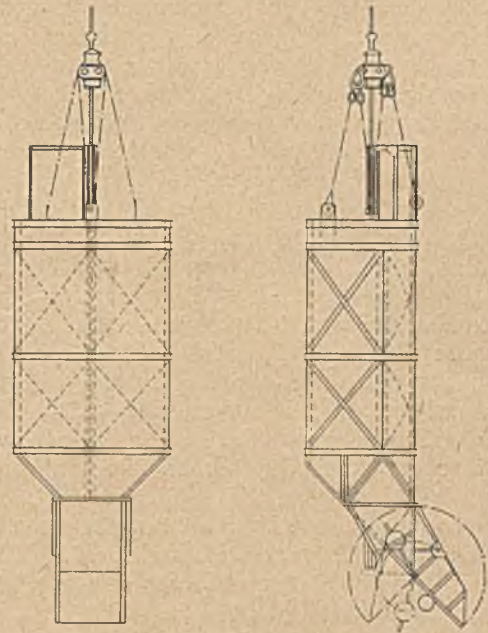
Vorderansicht mit geschlossener Auslaufschurre. Abb. 16. Seitenansicht mit geöffneter Auslaufschurre.
